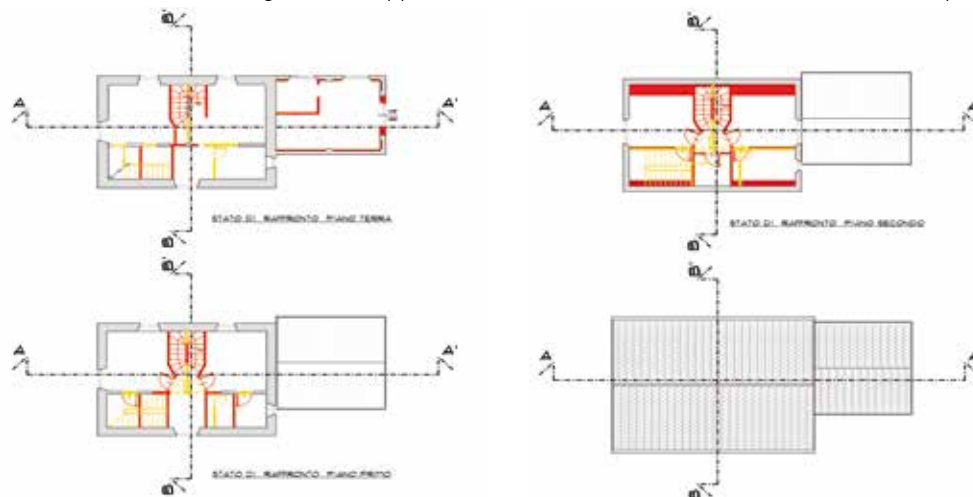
fase 1, appalto edifici A e B - demolizione e ricostruzione, planimetrie
